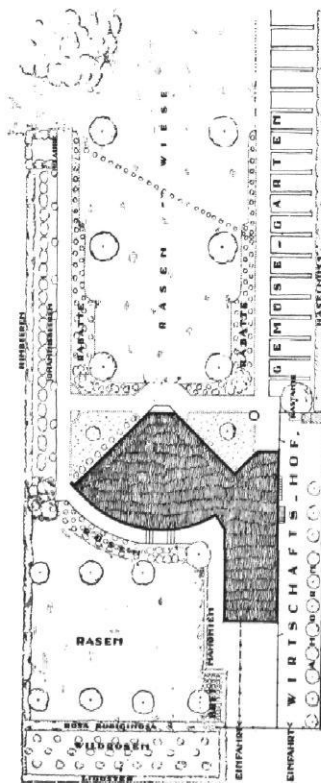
/ Lageplan des Taut'schen Hauses im Maßstab 1:666
